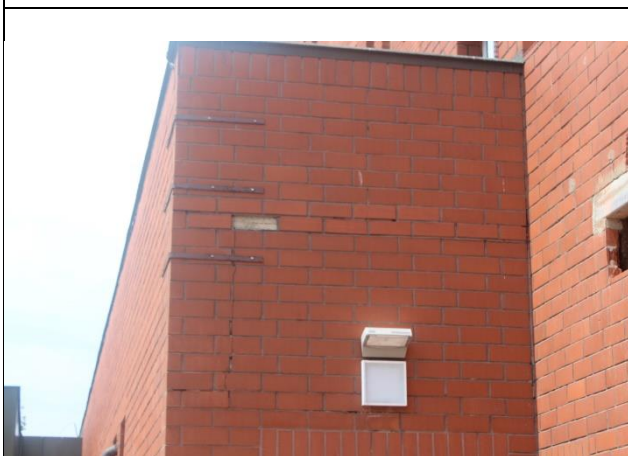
Widoczne odspajanie się elewacji zachodniej w poziomie ostatniego pietra.
